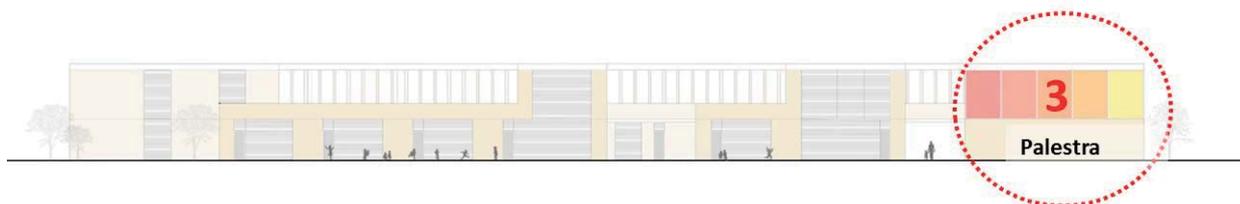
Prospetto Sud – Individuazione porzione fabbricato adibito a palestra (zona più vicina all'infrastruttura viaria)
